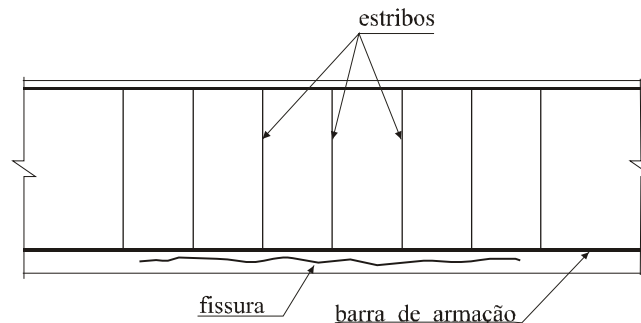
Fissuras causadas pela corrosão das armaduras
